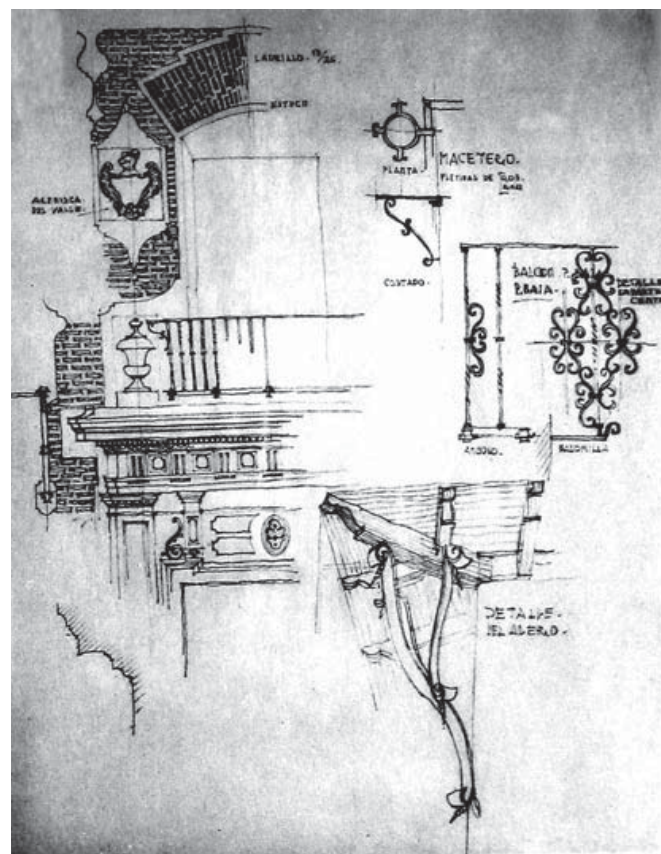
Detalles de la fachada Palacio de las Balsas, Murcia. *Arquitectura Española*, 1927
